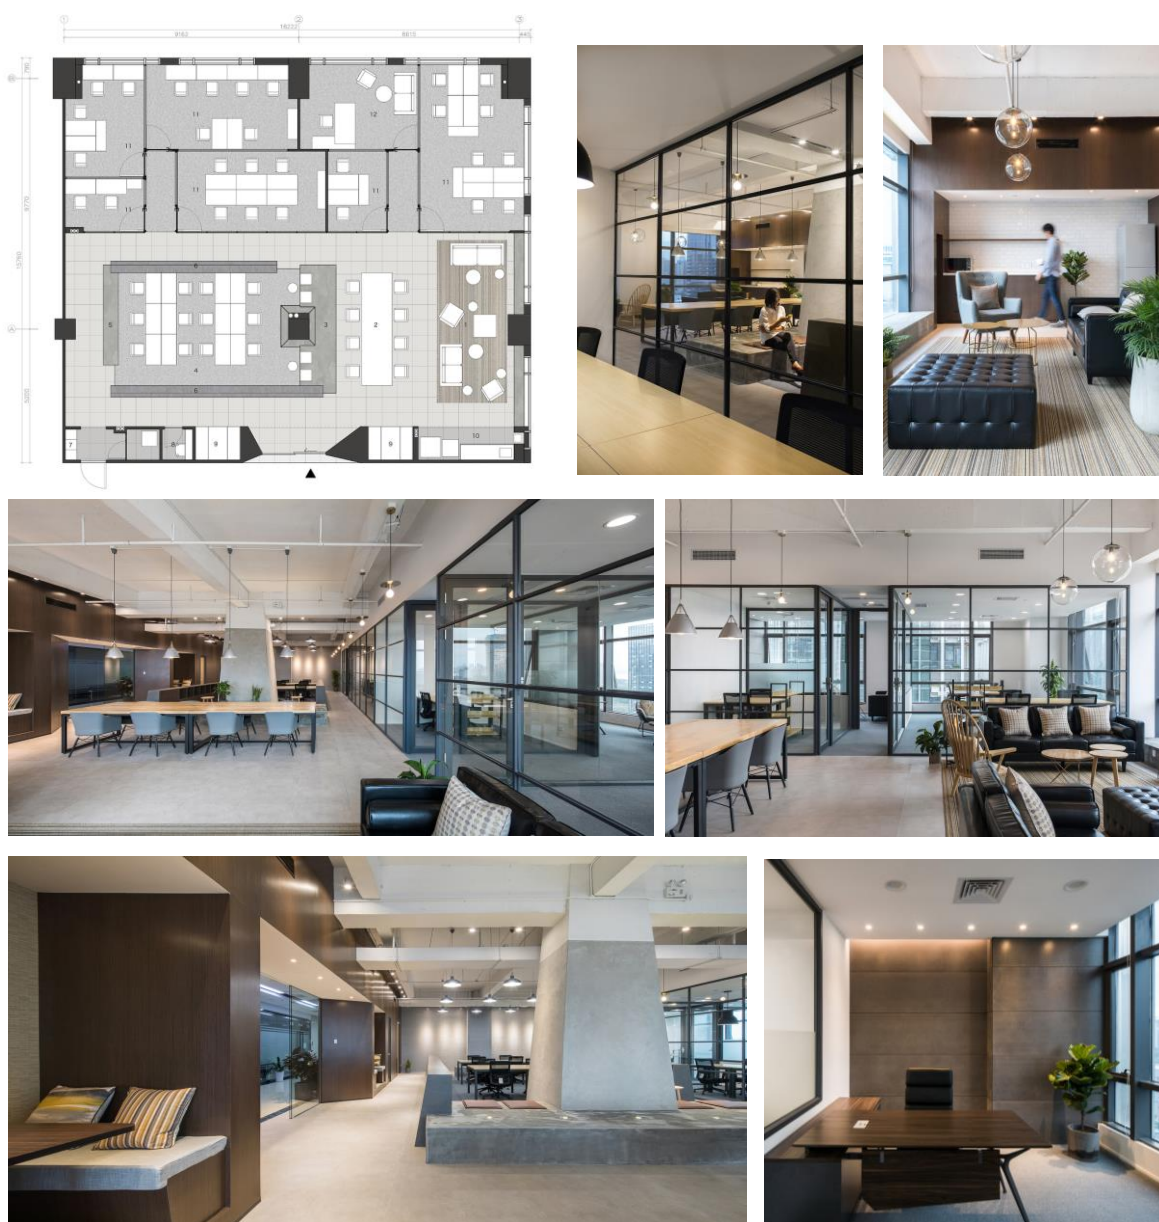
Planta e fotografias do interior. Fonte: Archdaily.
